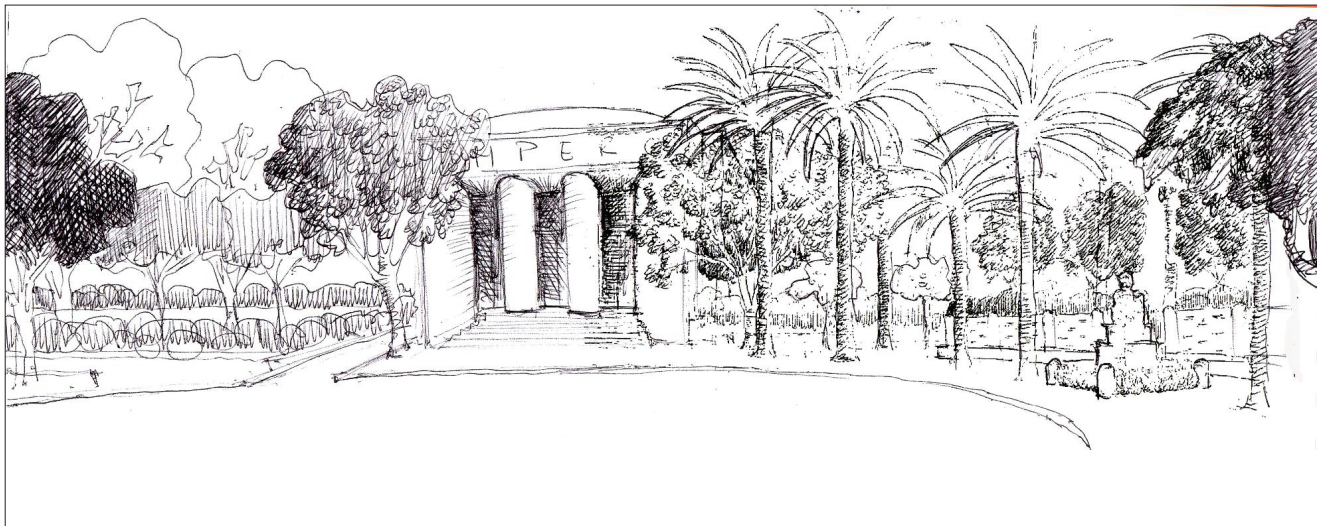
Schema prospettico attuale del Piazzale Vittorio Veneto.
